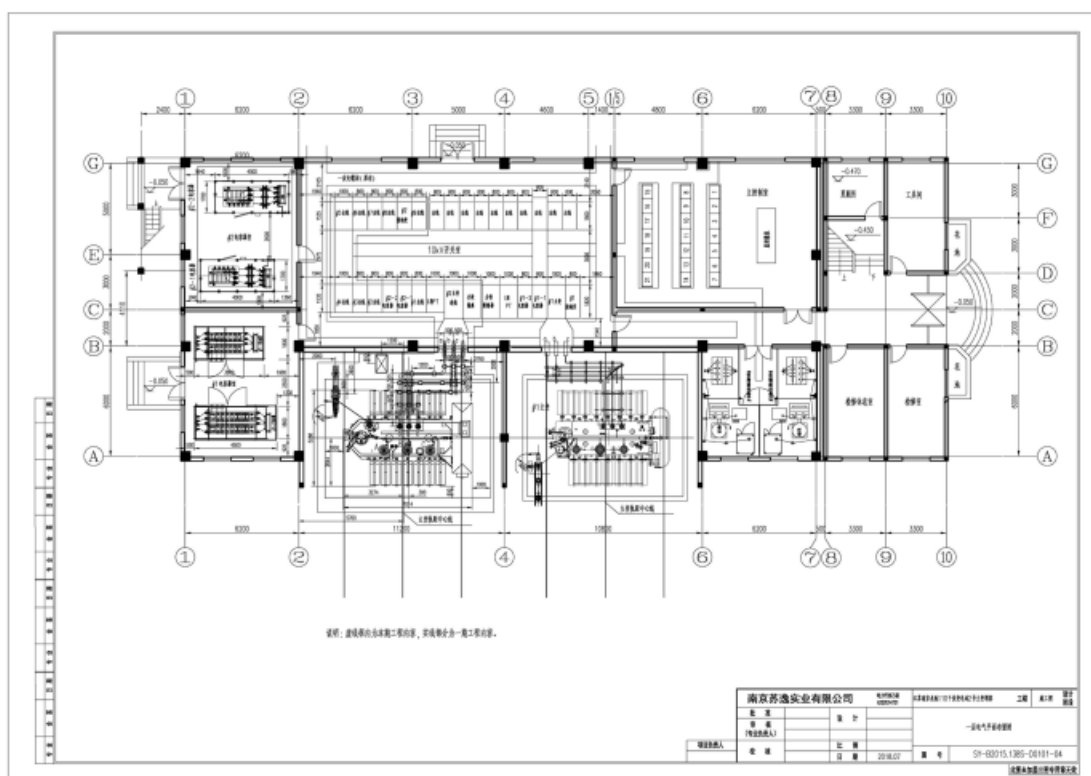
龙池 110kV 变电站电气平面布置图
